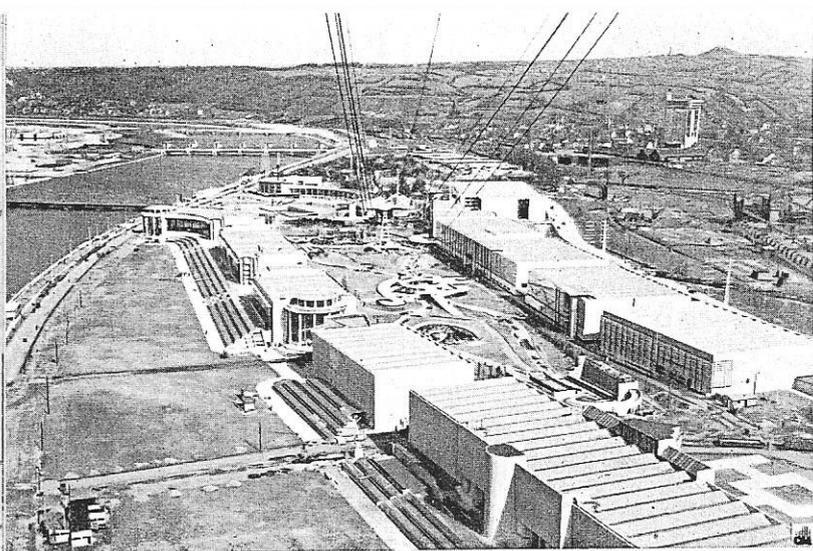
Vue générale des constructions de la rive droite, prise du haut du téléphérique.
